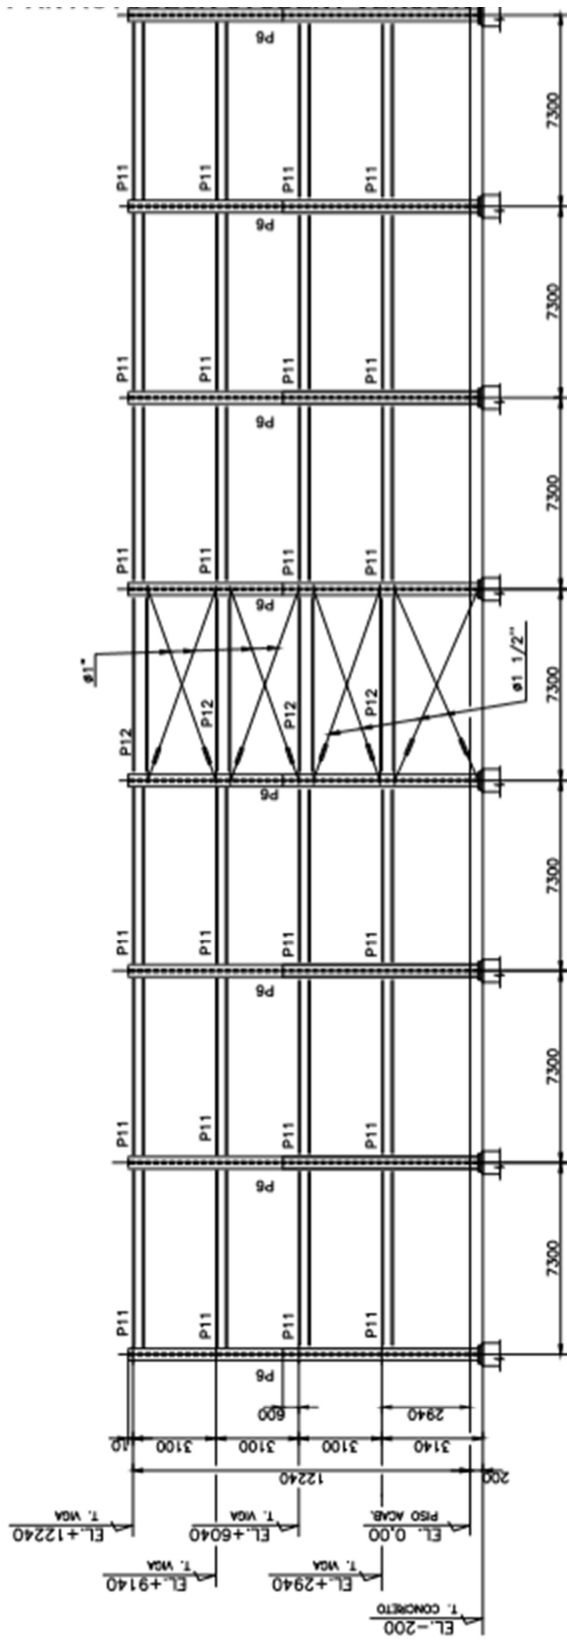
Elevação e contraventamentos (Fonte: Projemax Projetos Industriais)
